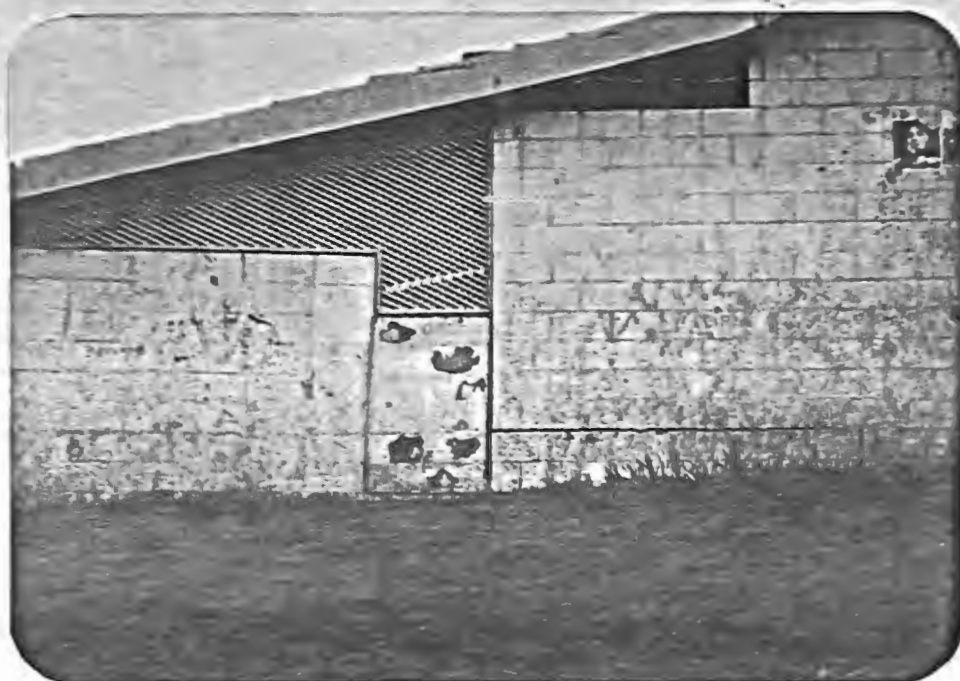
VISTA DA FACHADA LATERAL DO IMÓVEL 224,
